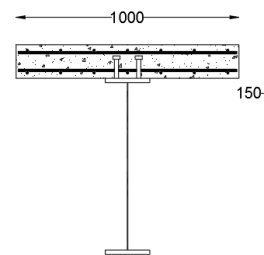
Secção tipo das vigas do ensaio MI 2
